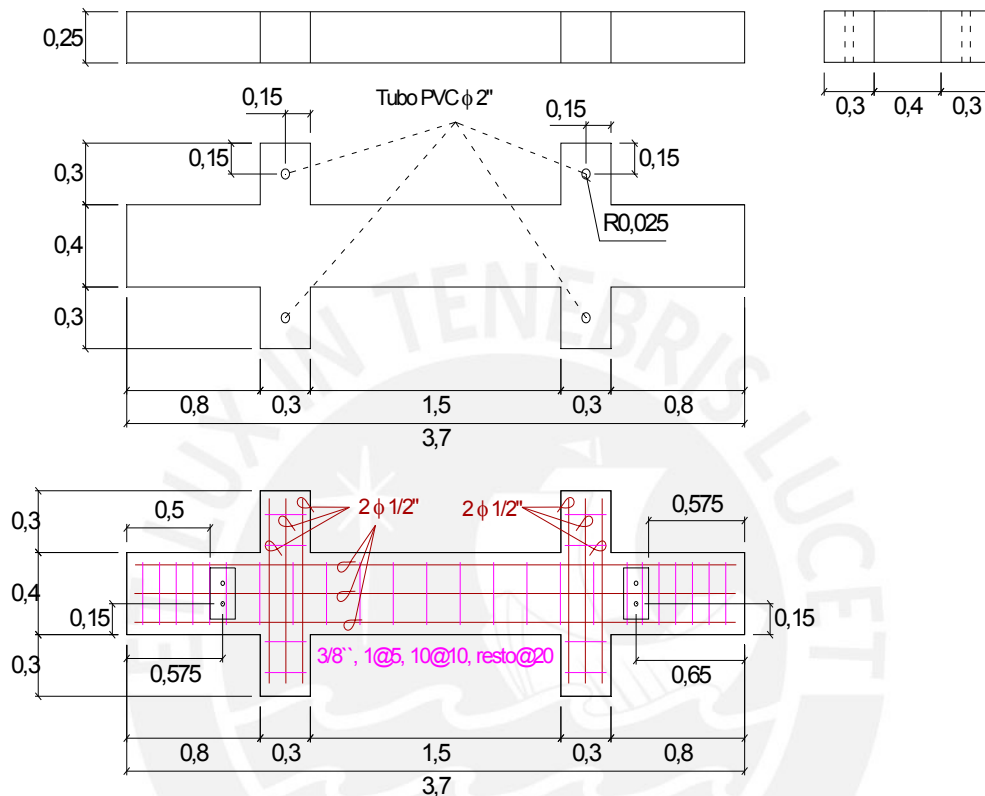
Características geométricas y refuerzo de la viga de cimentación
